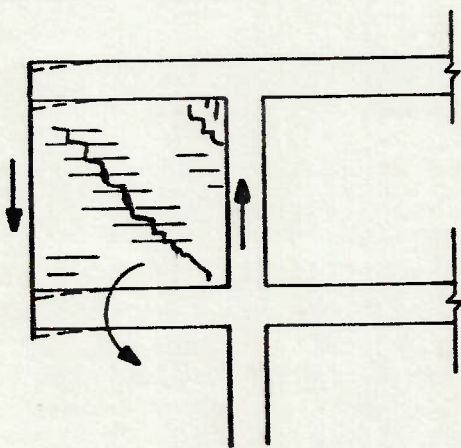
Trincas na alvenaria, provocadas por deflexão da região em balanço da viga
